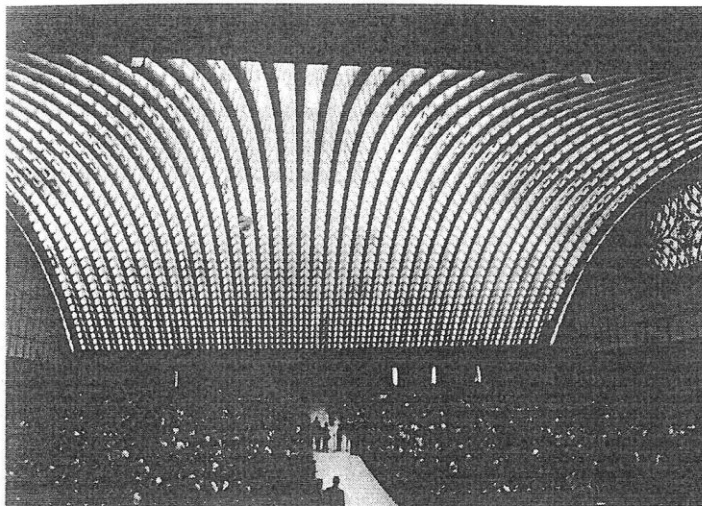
Vista interior de la cubierta de la sala. La estructura cumple, además con las funciones de paso y distribución del aire acondicionado, insonorización e iluminación.
